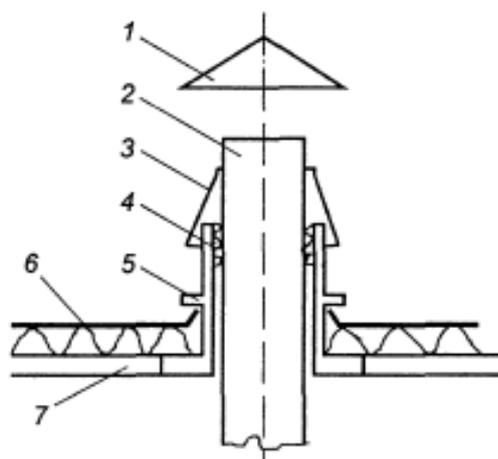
Проход вытяжного воздуховода через плоскую кровлю:
